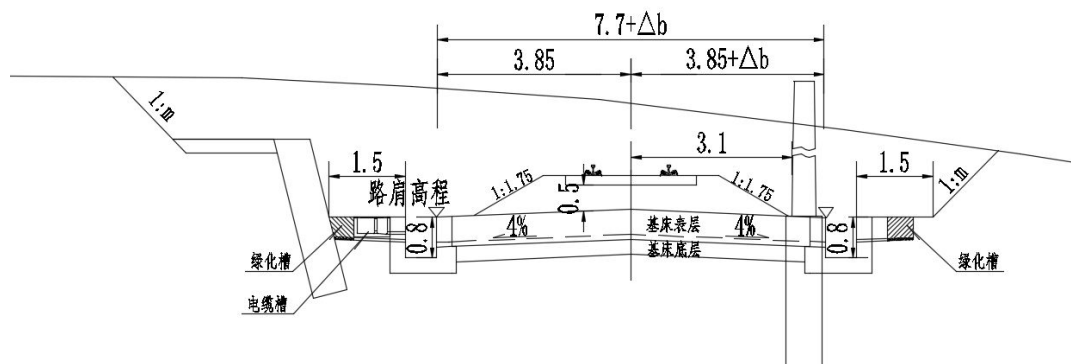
4 东环线正线单线绕行路堑标准横断面 (m)
